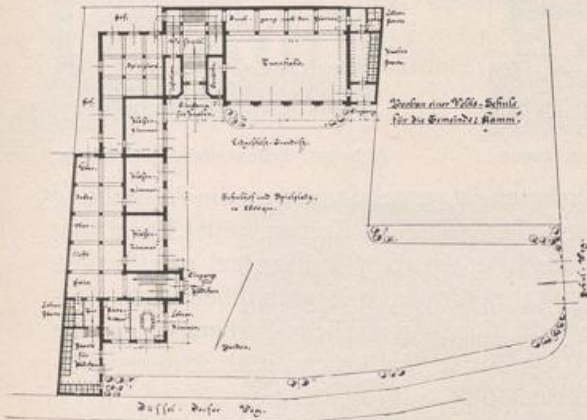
Lageplan und Erdgeschoss der Schule im Vororte Hamm.
